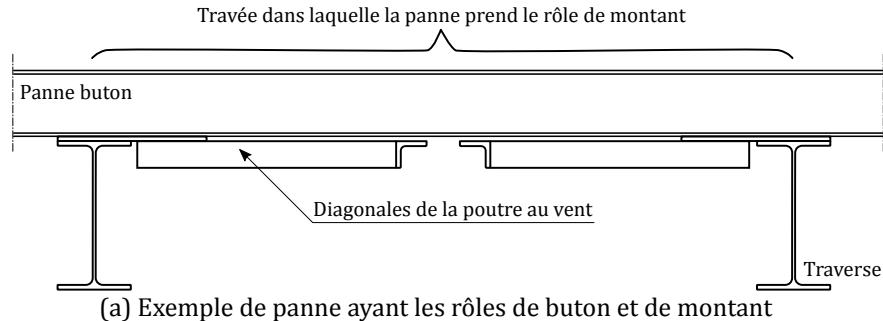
Fonction montant de poutre au vent – dispositions constructives
